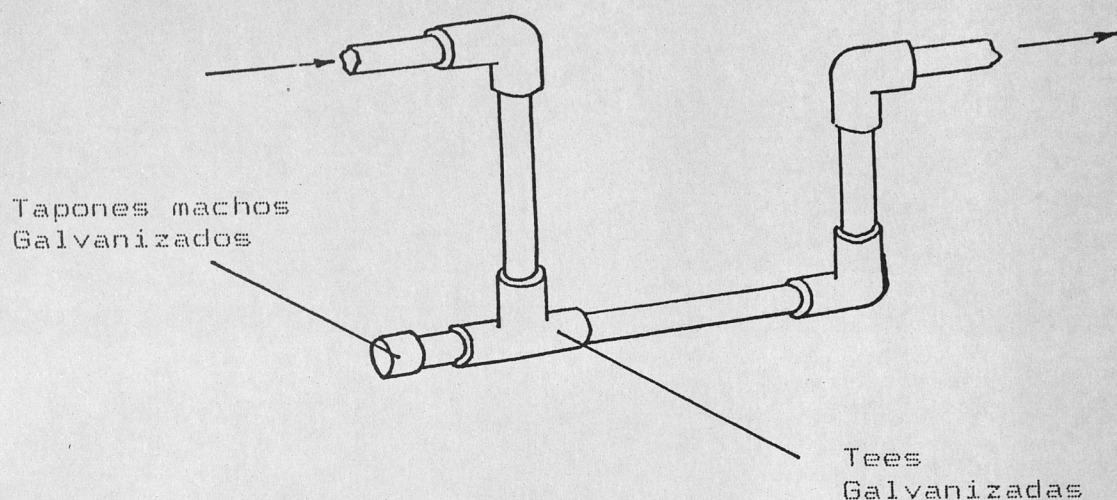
Detalle de trampa en drenaje de líquido condensado.
